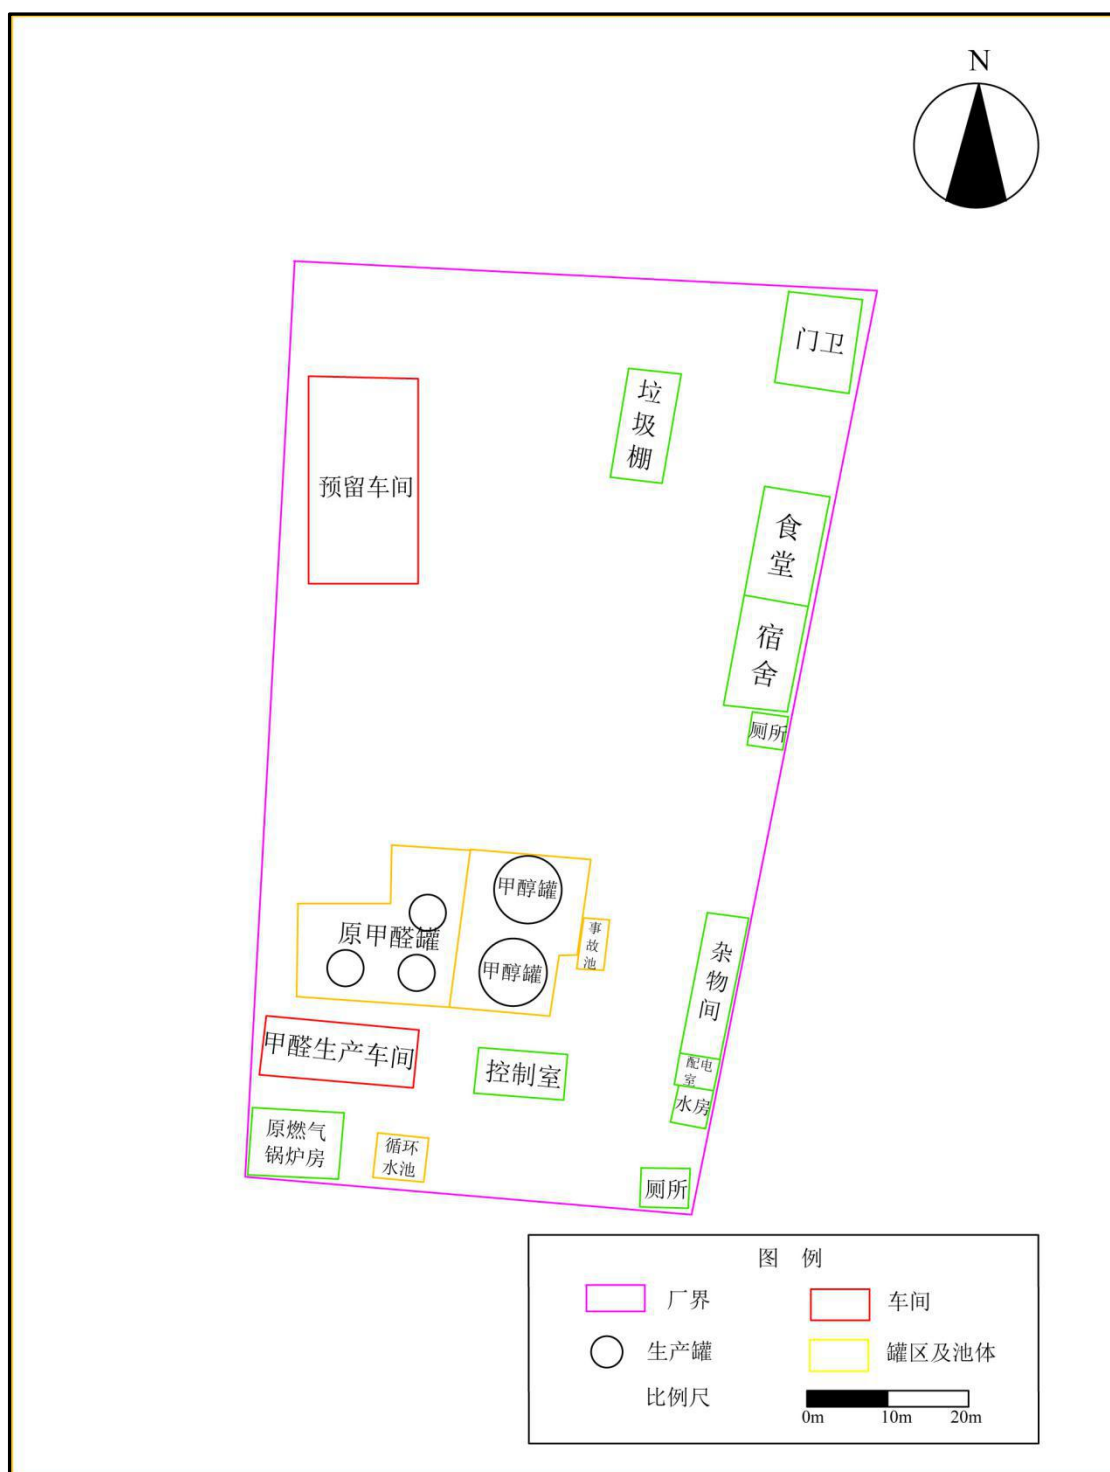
2002-2007 石家庄中天化工有限公司厂区平面布置图
